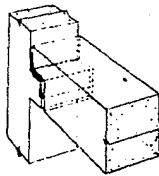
COLUMNA A BASE (CIMENTO).
